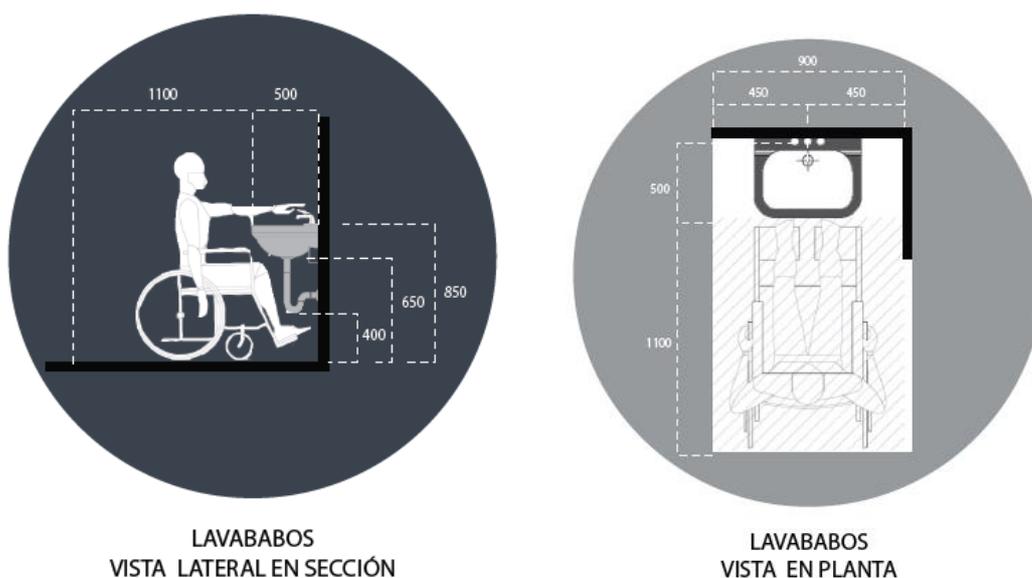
Diagrama en sección y en planta del lavabo según Normativa INEN. (Vinueza, B.)
